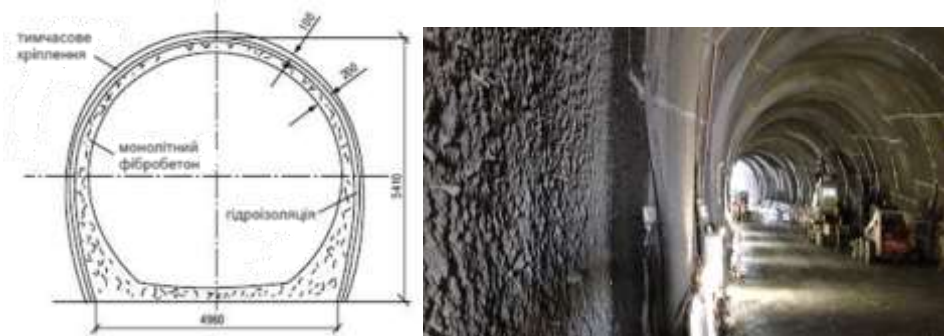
Фібробетонне кріплення виробок (набризк-бетонування)
